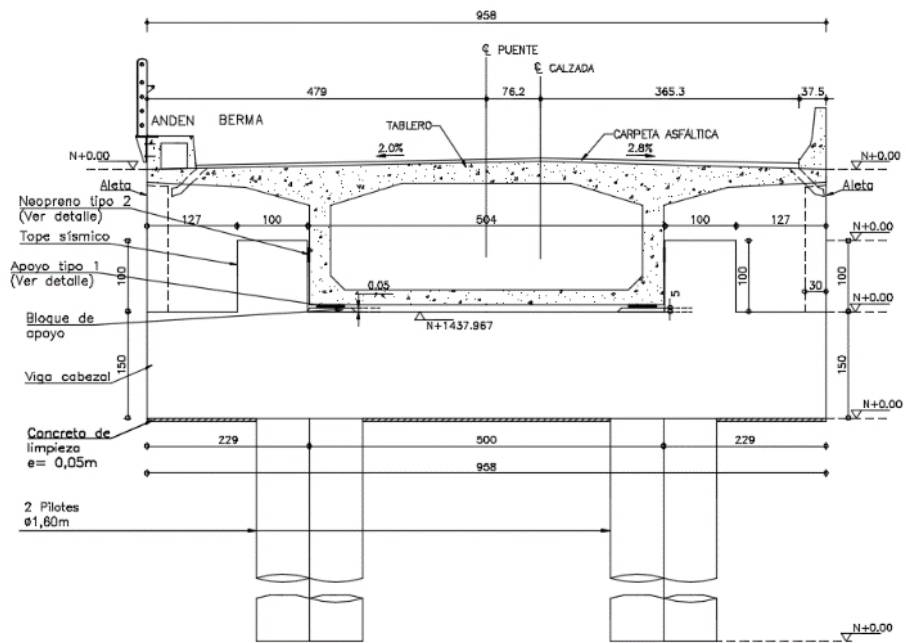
Geometría apoyos ejes 1 y 4 – Puente Bermúdez
